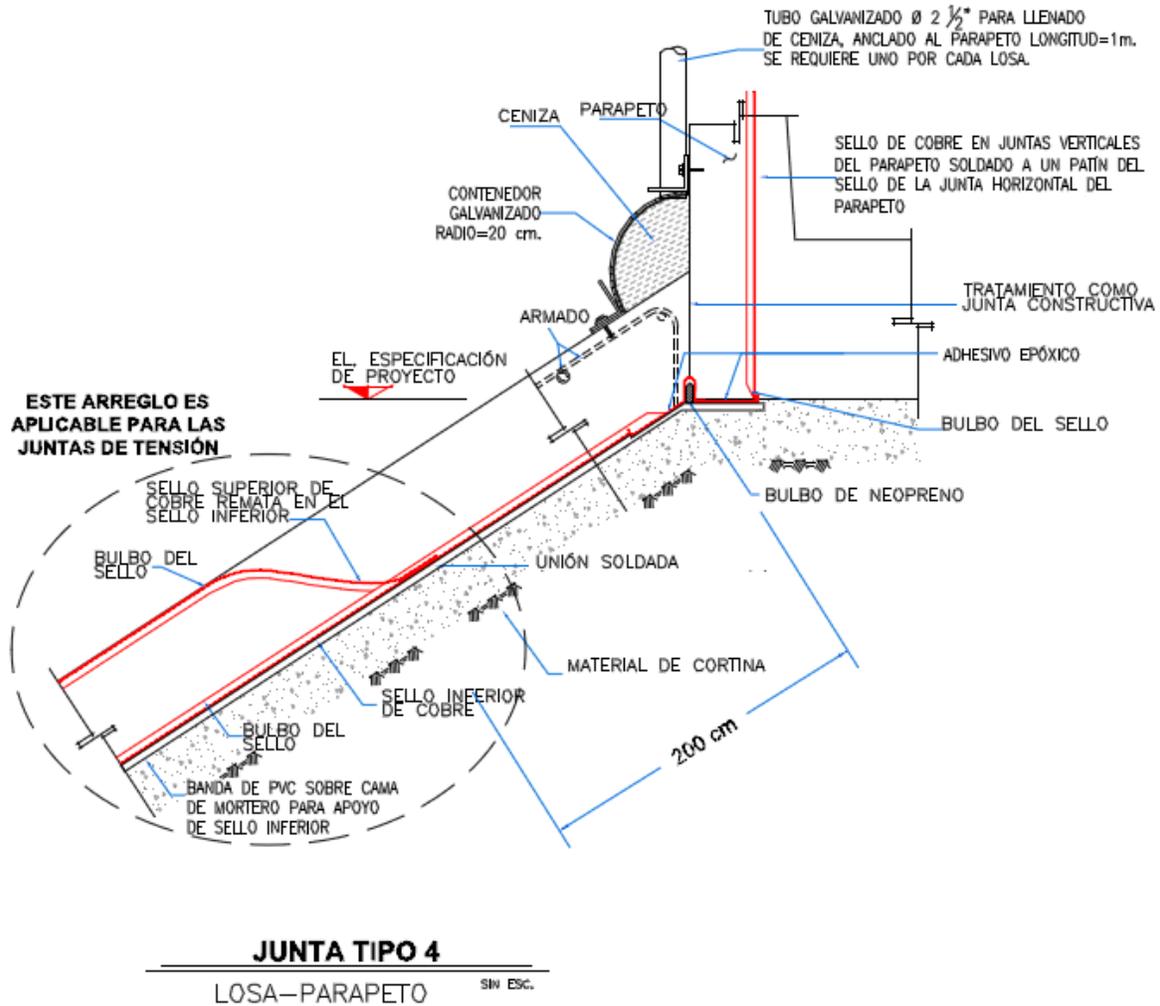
Detalle de la junta de parapeto (Tipo 4).
